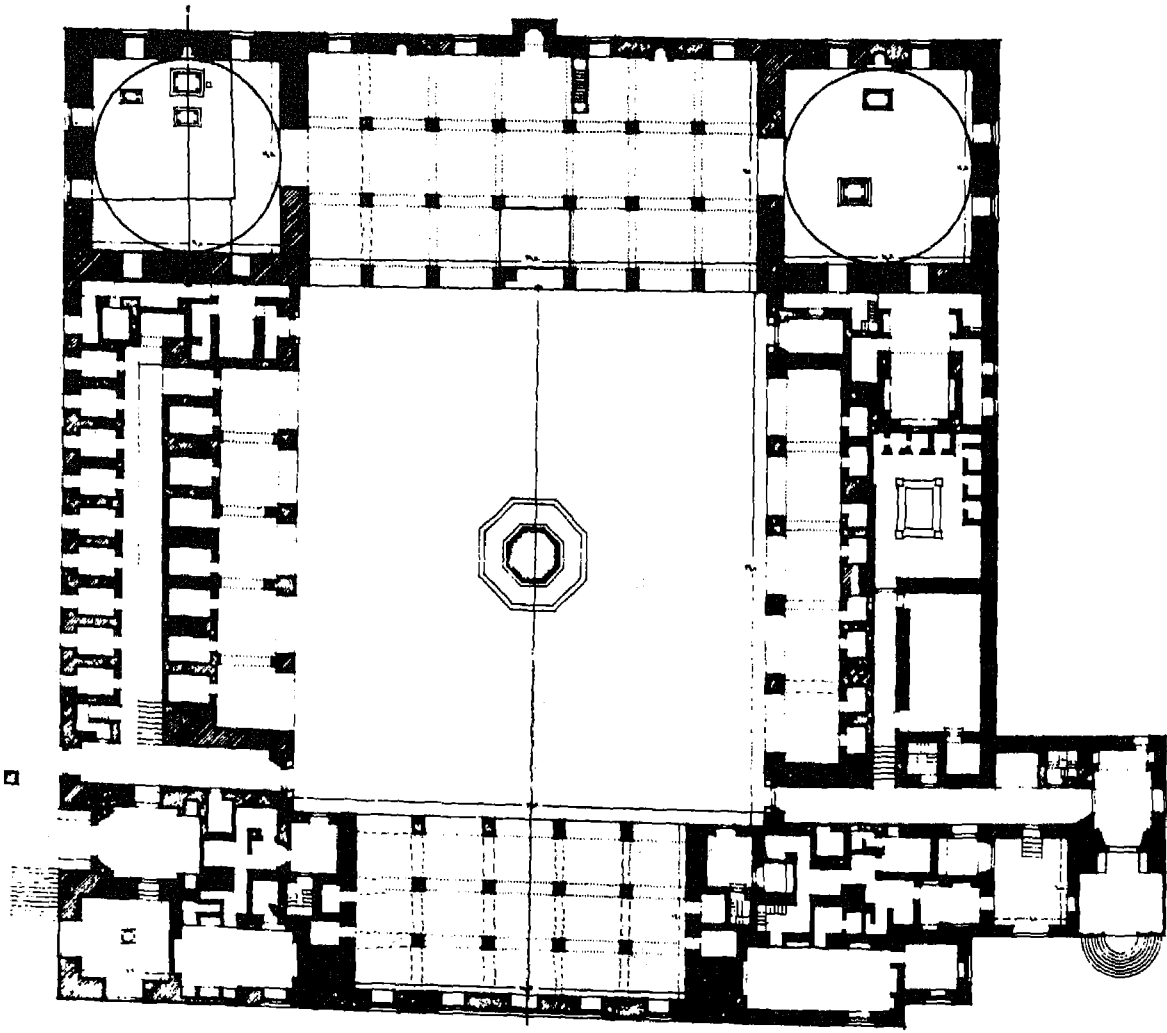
مسقط أفقى لجامع الأقمير
